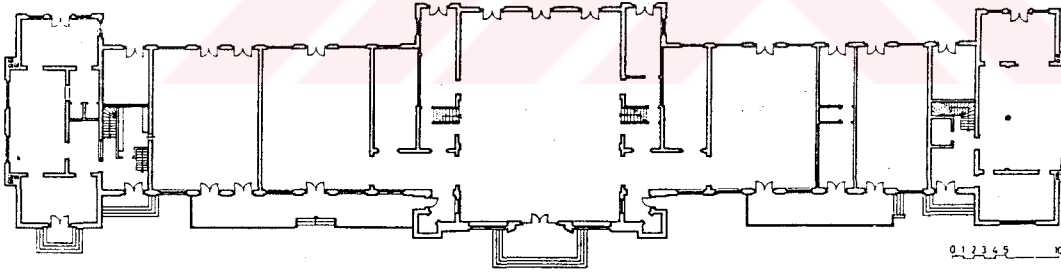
Sirkeci Garı Vaziyet Planı
